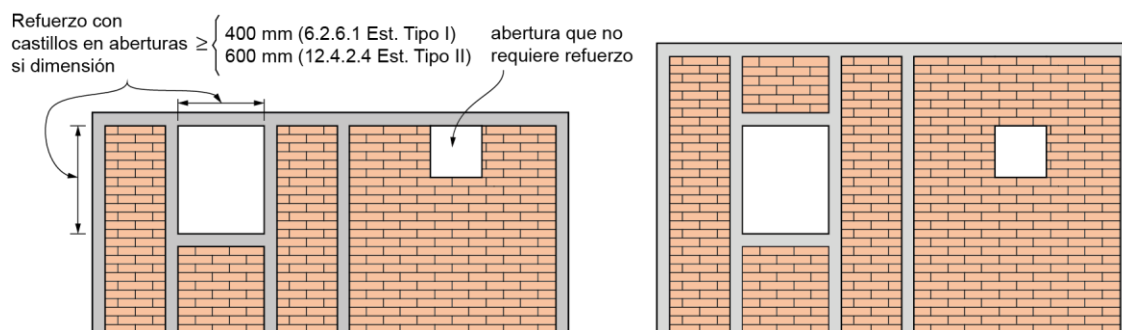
Refuerzo en el perímetro de aberturas
